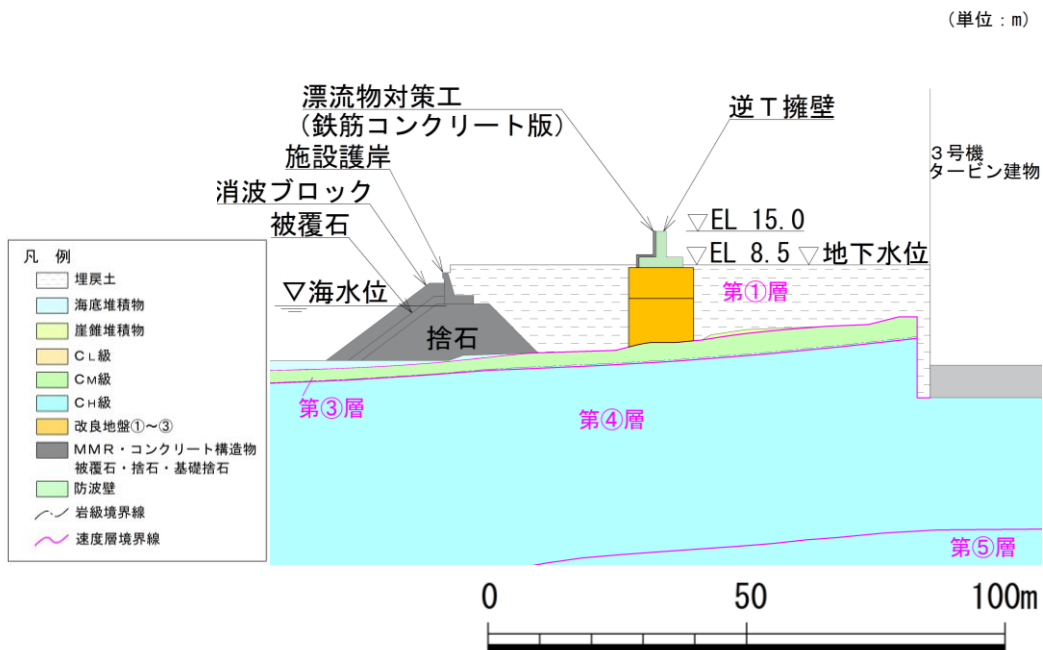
防波壁 (逆 T 擁壁) の横断面図 (④-④断面)
